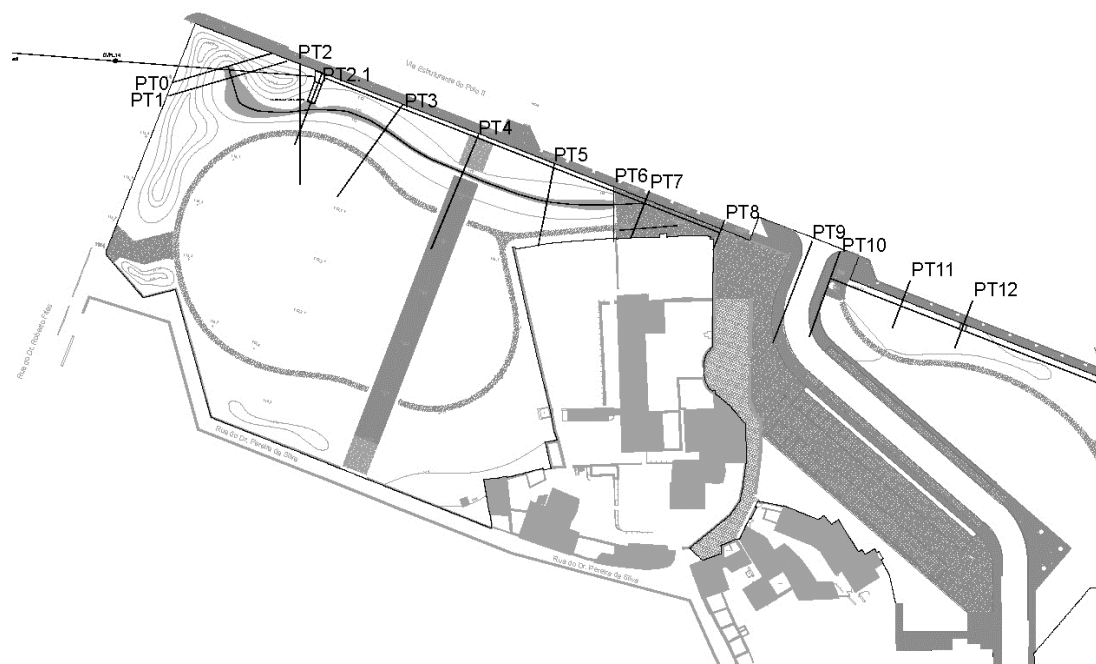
Localização dos perfis transversais ao longo do troço da ribeira
